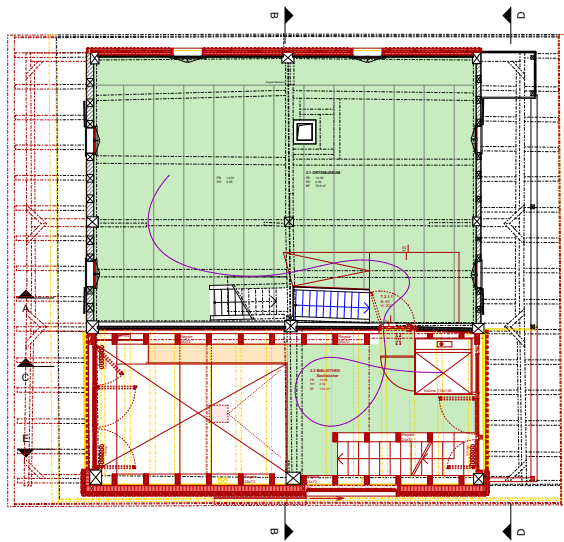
Grundriss 2. OG Zugänglichkeit Konzept
